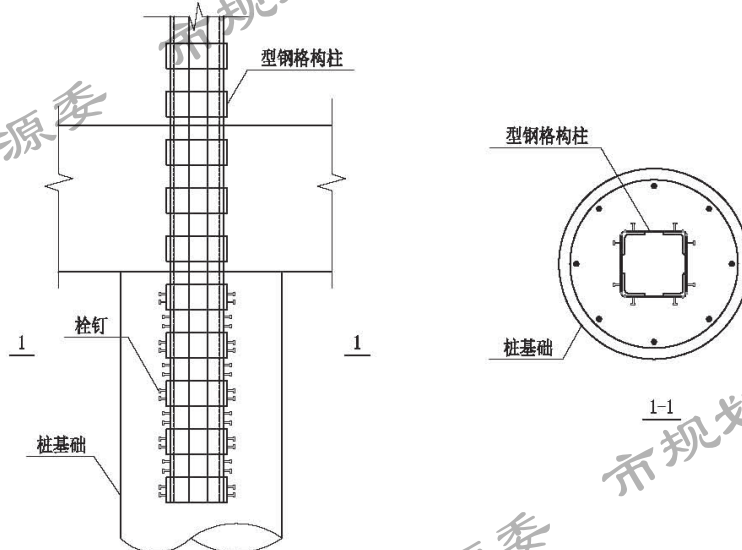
型钢格构柱插入中间桩基础节点示意
